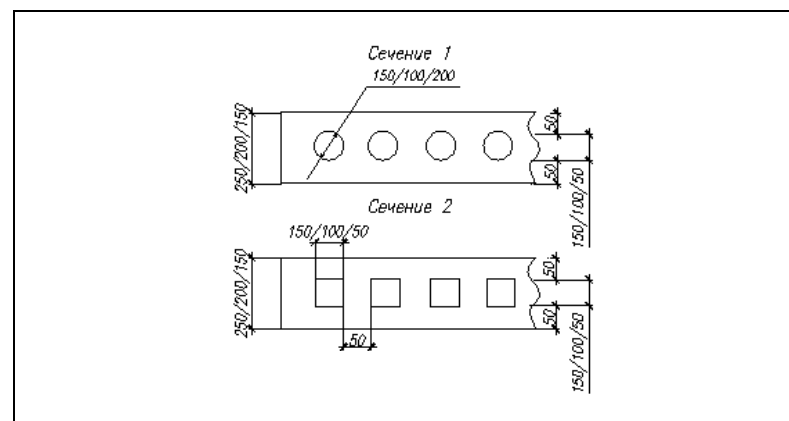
Схемы плит перекрытий с различными формами сечения пустот: сечение 1 – круг, сечение 2 – квадрат
